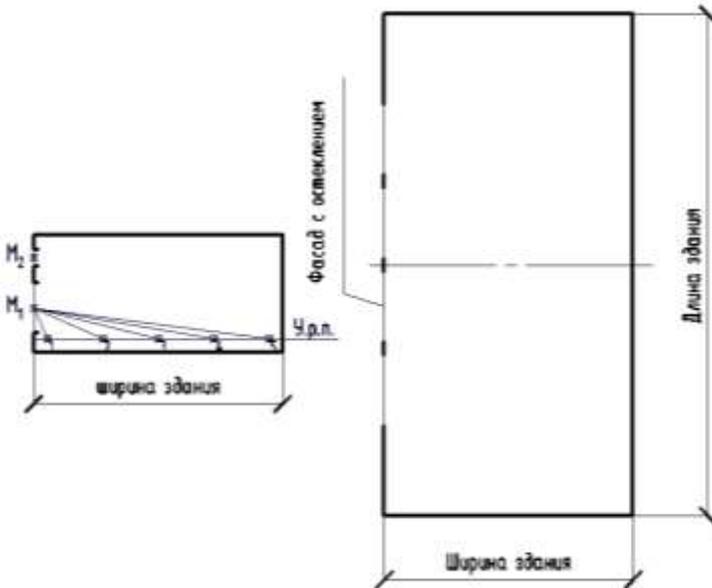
План и разрез производственного здания к определению геометрического КЕО
